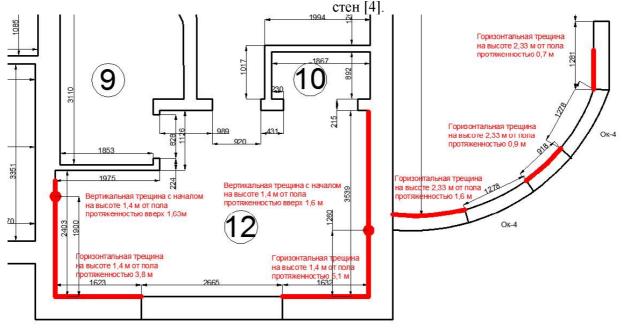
Фрагмент плана здания с указанием мест расположения трещин
